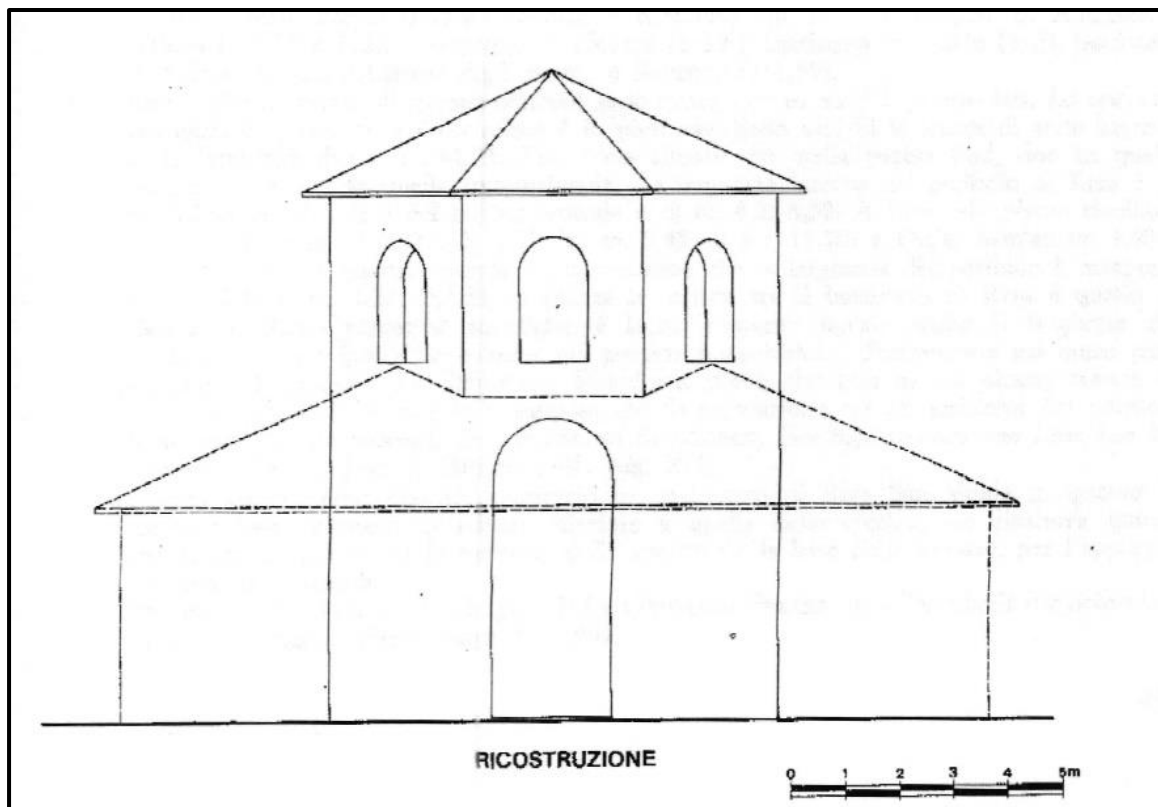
Baveno. Ricostruzione dell'elevato del battistero (Mazza 1973-1975, Tav. V, p. 449).
